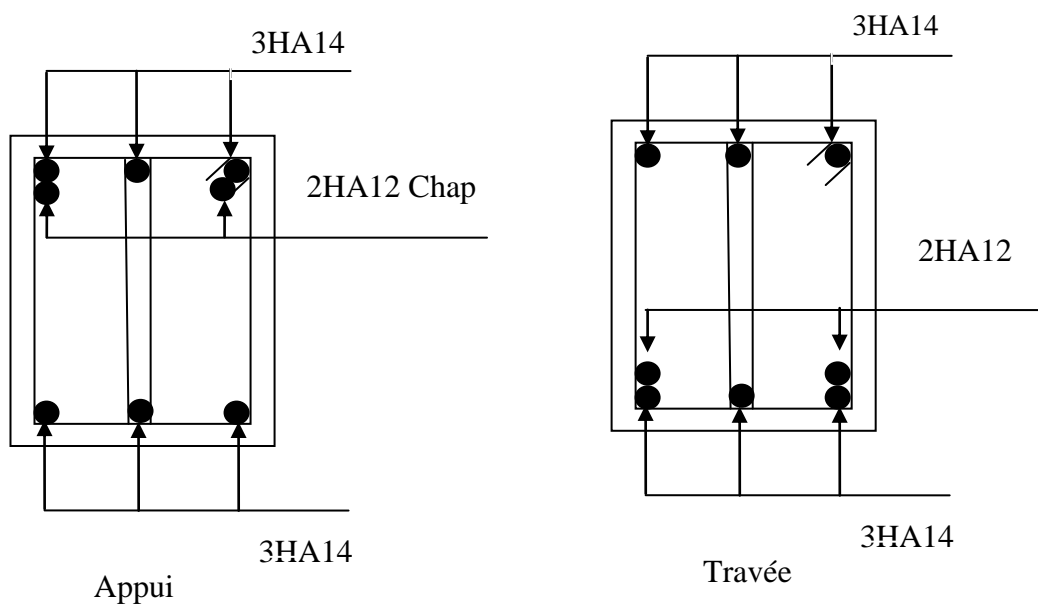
Schéma de ferrailage des poutres secondaires pour tous les niveaux
